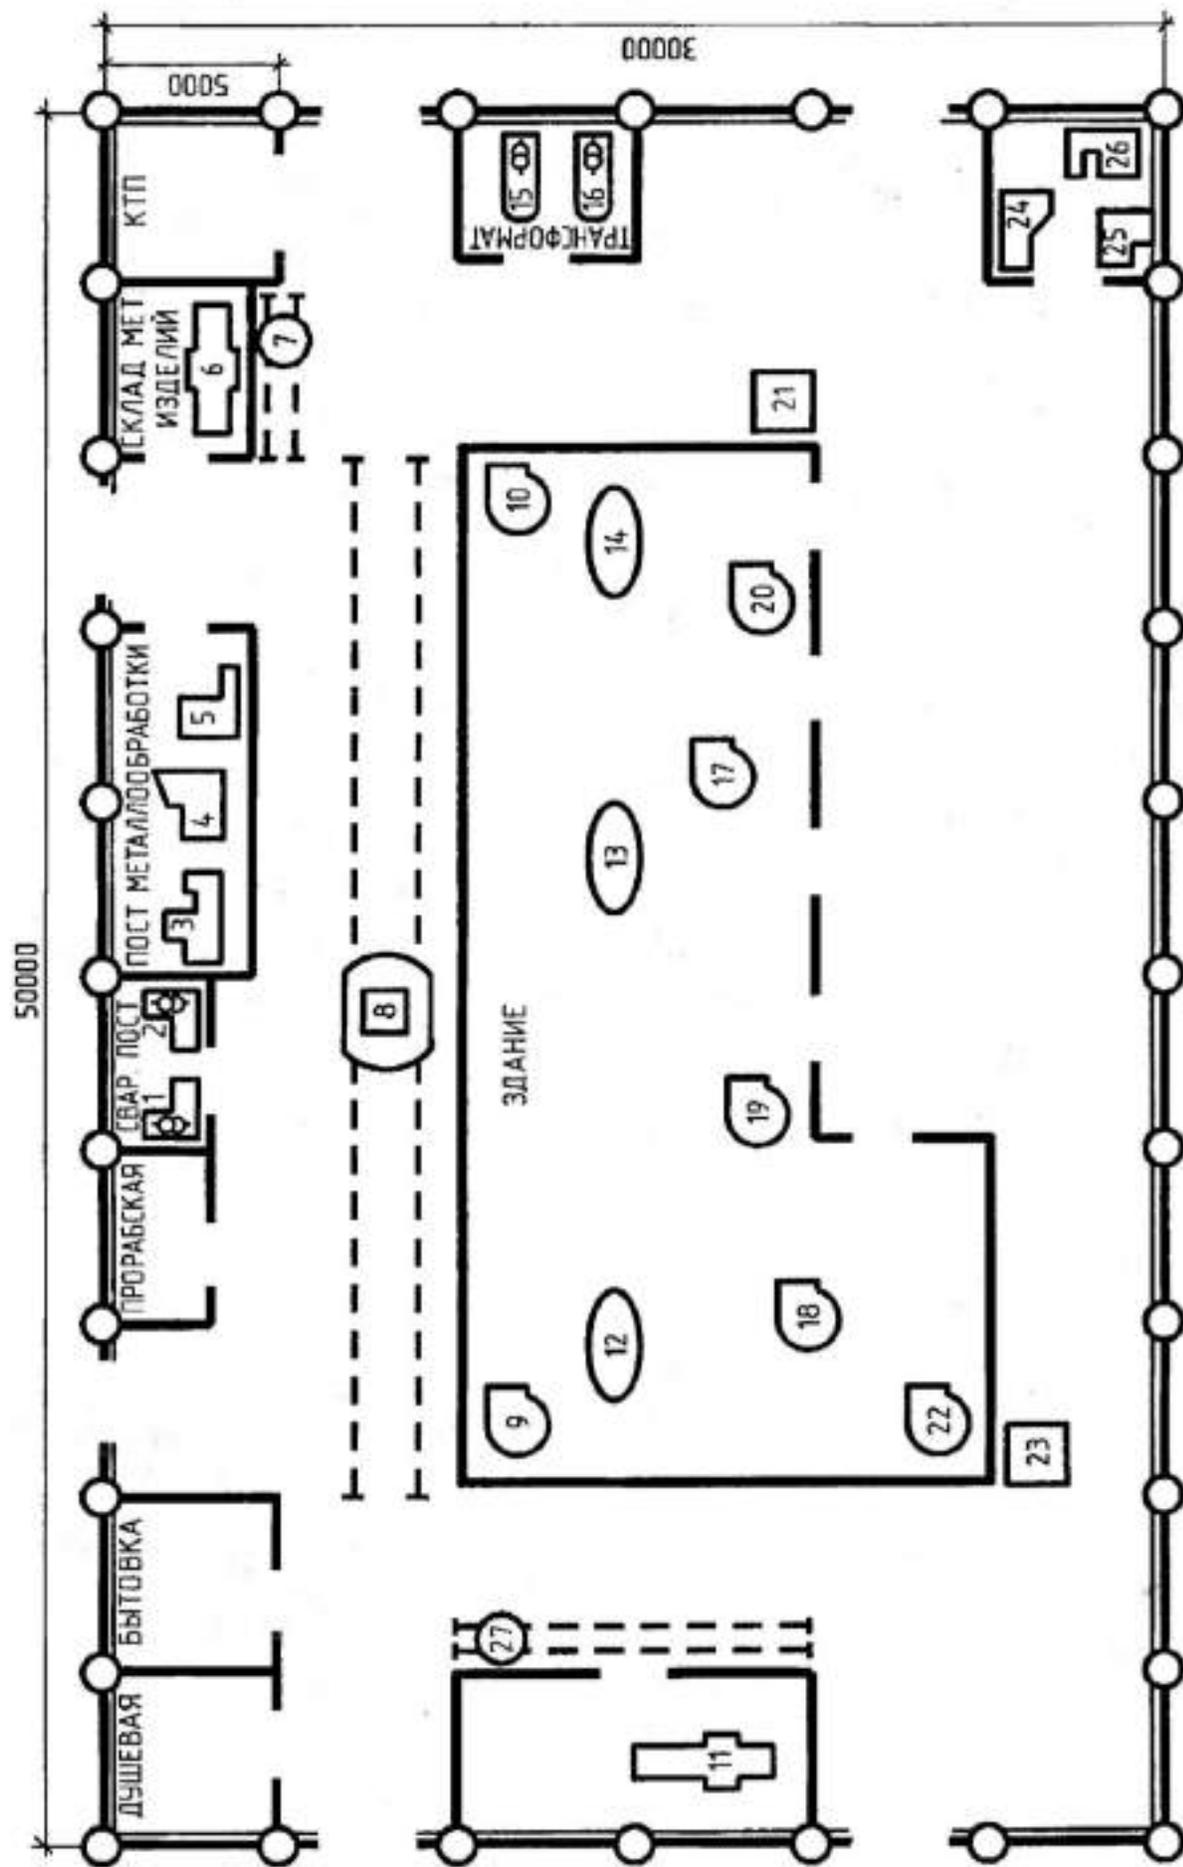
План расположения ЭО строительной площадки жилого дома
